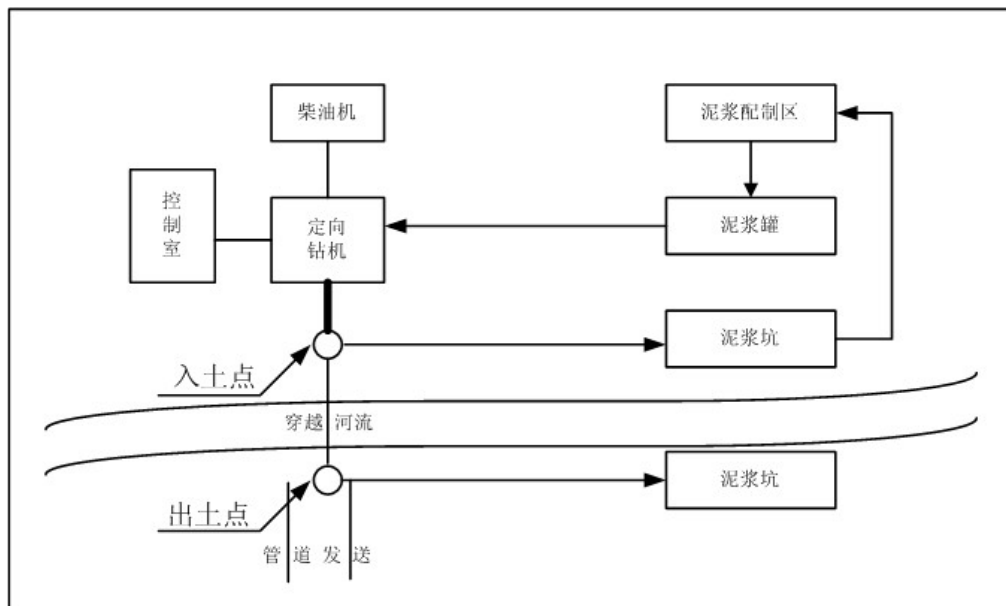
定向钻穿越施工作业场地平面布置示意图
